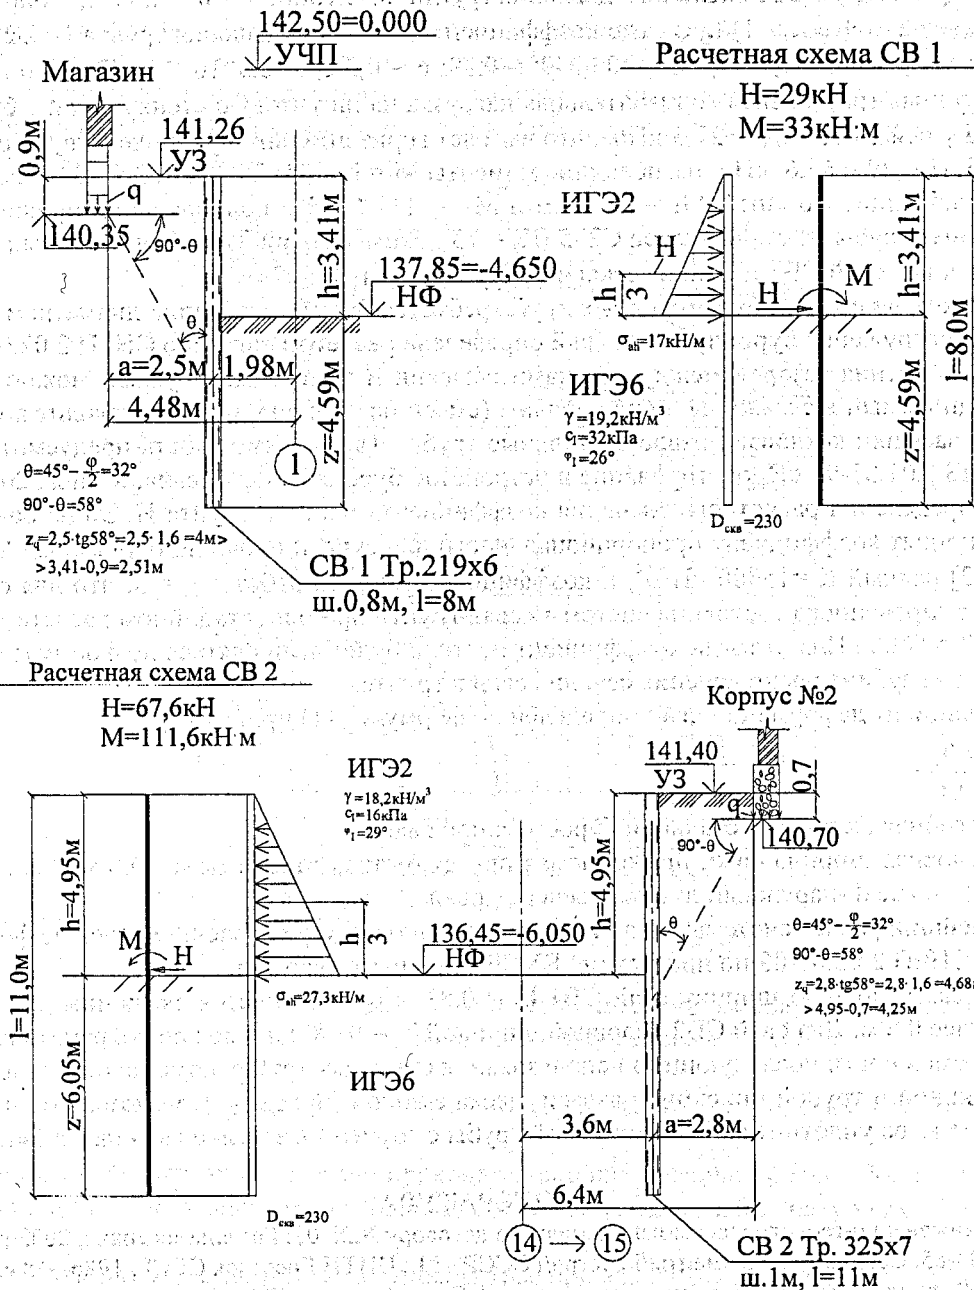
К расчету шпунтовых стенок из буропусковых свай СВ1 и СВ2 у осей 1 и 14 при строительстве офисного центра
